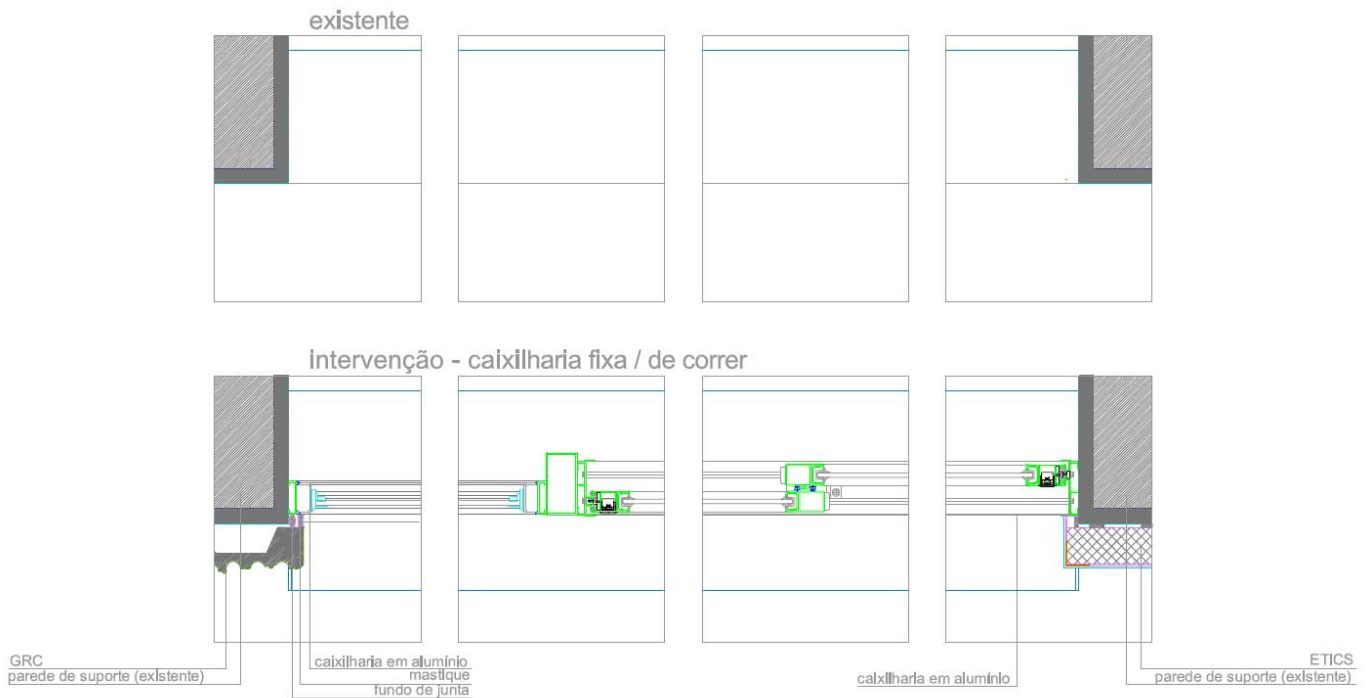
Novo caixilho de correr da lavandaria. Pormenor construtivo horizontal (escala 1/10).
